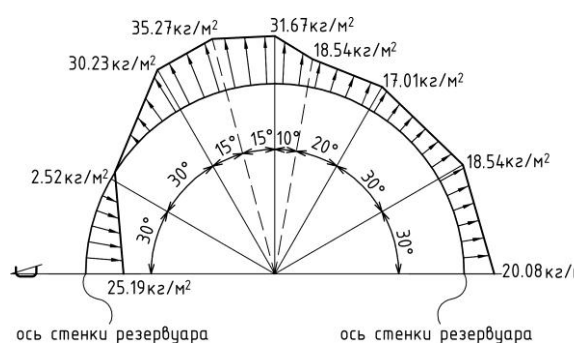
Схема приложения ветровой нагрузки на 1-3 пояса стенки резервуара
